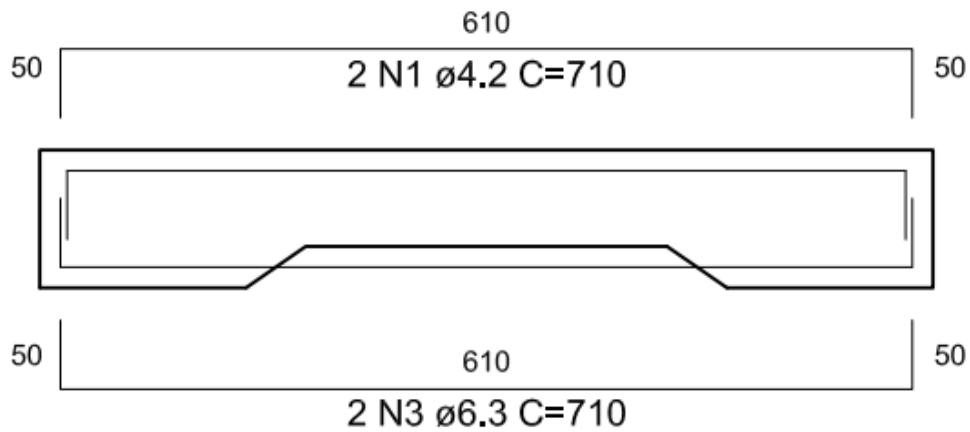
Detalhamento da armadura 2: barras de aço longitudinais (dimensões em mm).
